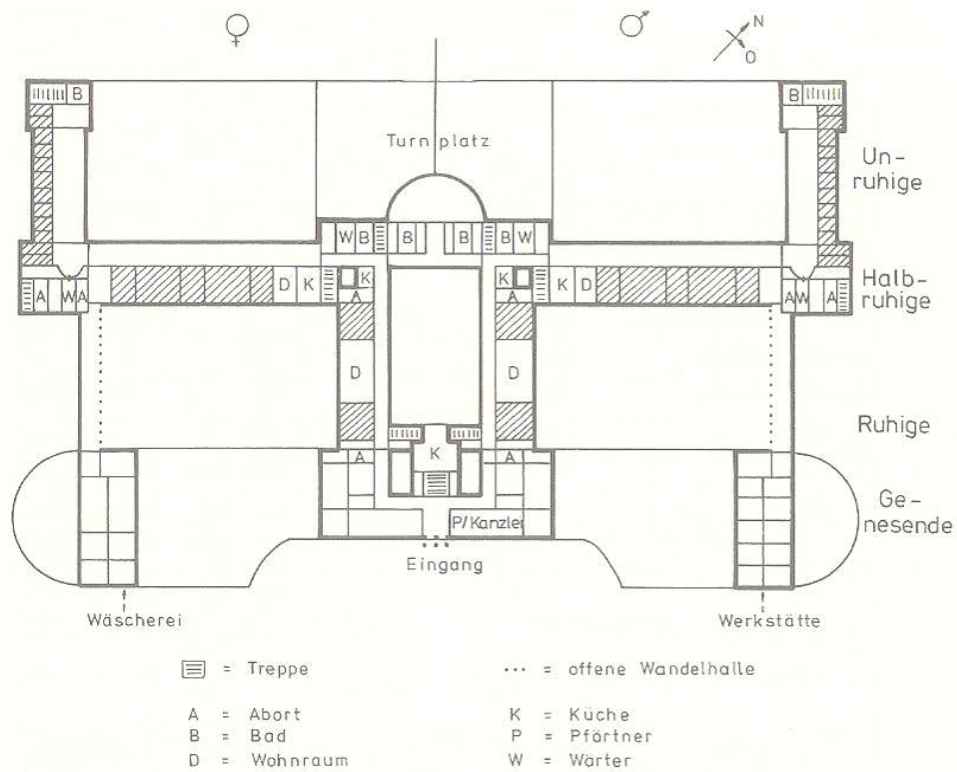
Grundriss der Wiener Irrenanstalt am Bründlfeld, 1852
